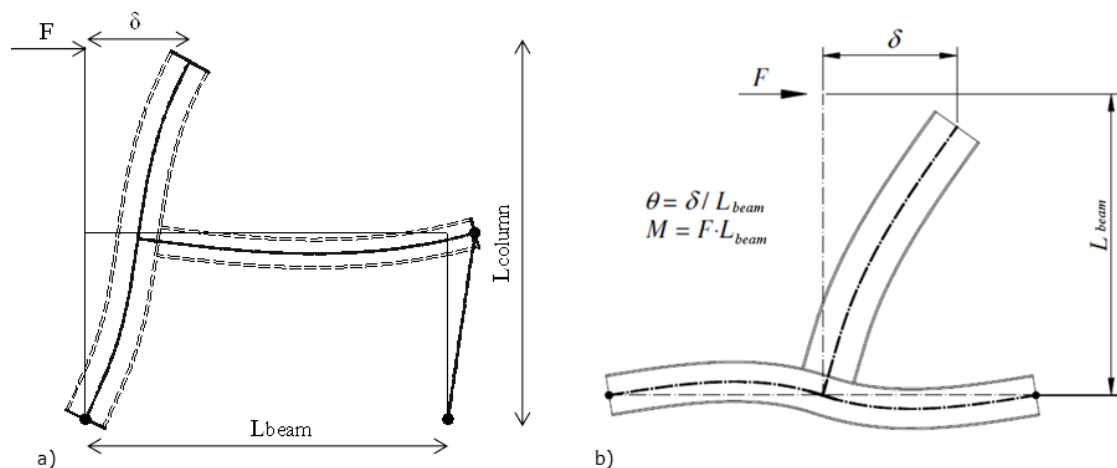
Definição dos parâmetros da juntas viga-coluna ensaiadas, aplicando a carga: (a) na extremidade da coluna; (b) na extremidade da viga
